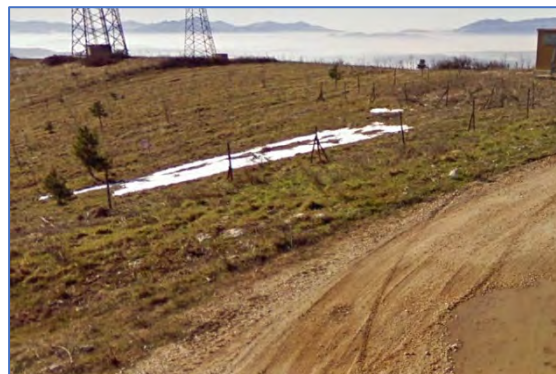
stradina di collegamento tra SMC03-SMC04, vista da nord
